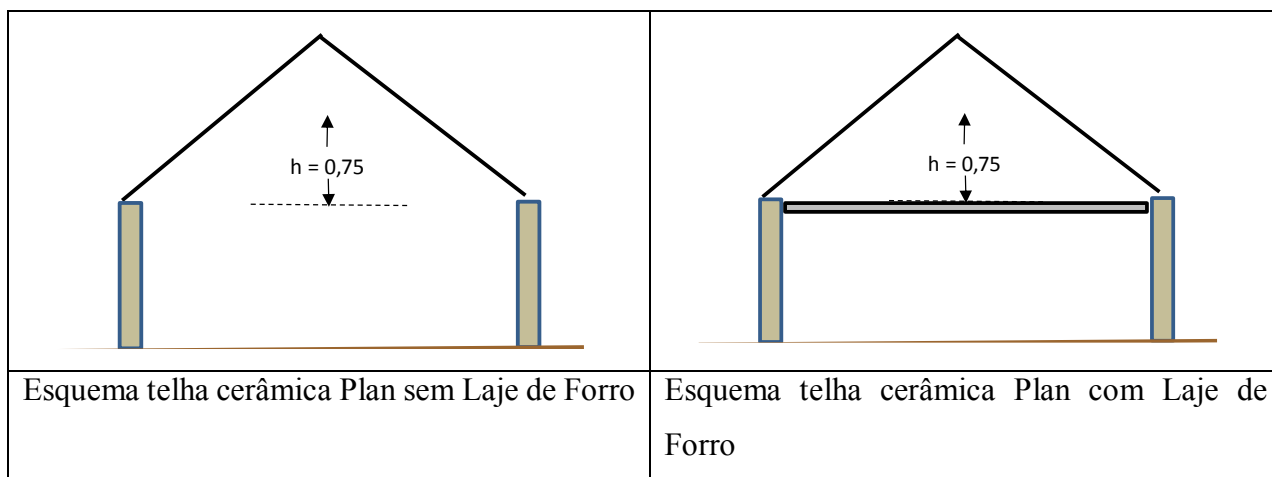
Esquema da cobertura com telhas cerâmica tipo Plan (Autor)
